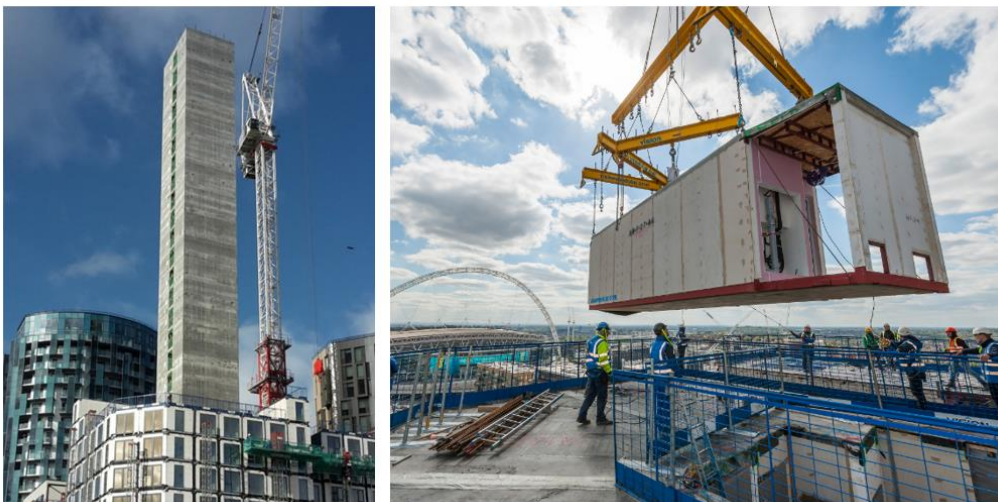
Núcleo de hormigón Apex House (izq.). Colocación de un elemento modular (dcha.).
